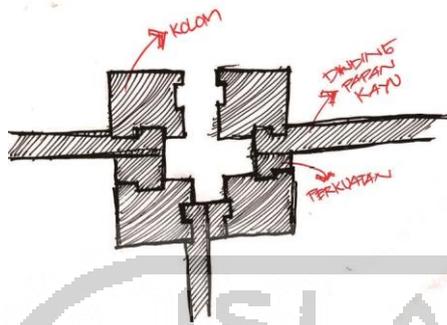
29 Tampak atas skema detail sambungan kolom dengan balok
